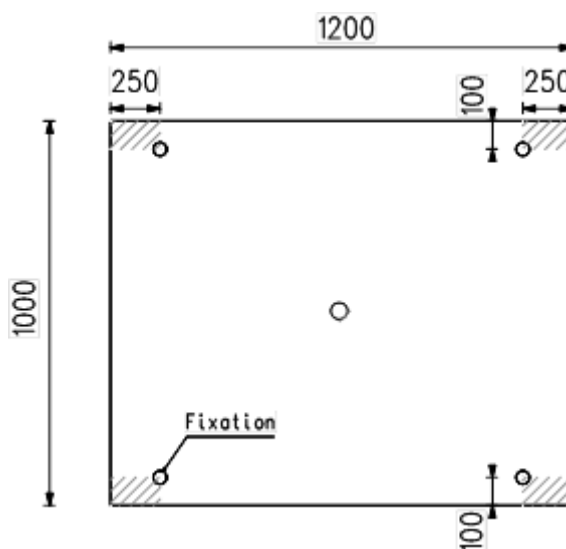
Fixation préalable des panneaux de dimensions 1200 x 1000
